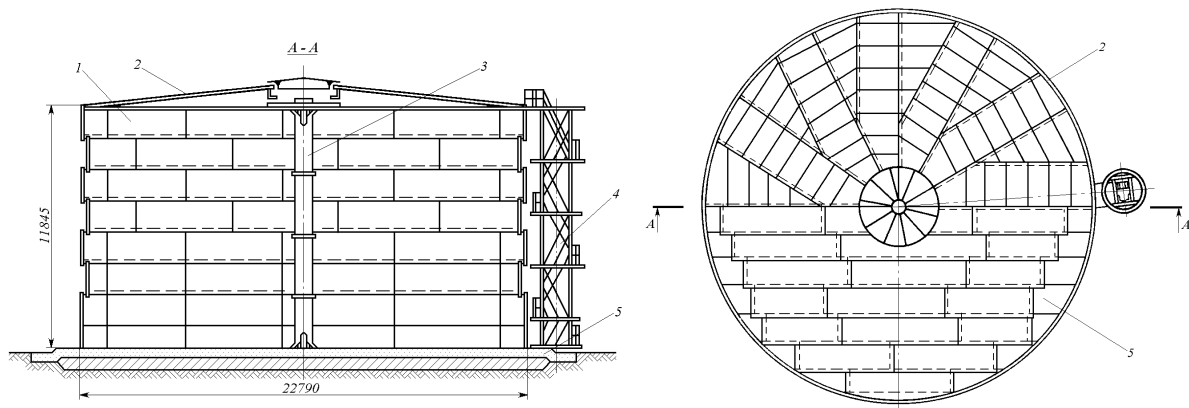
Стальной цилиндрический резервуар со щитовой кровлей
